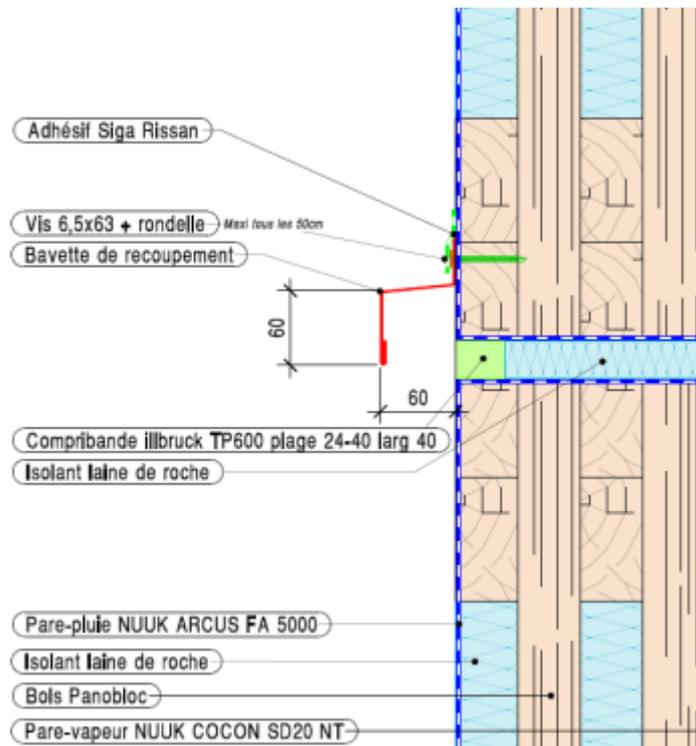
Essai AEV Jonction horizontale entre Panobloc / coupe verticale
